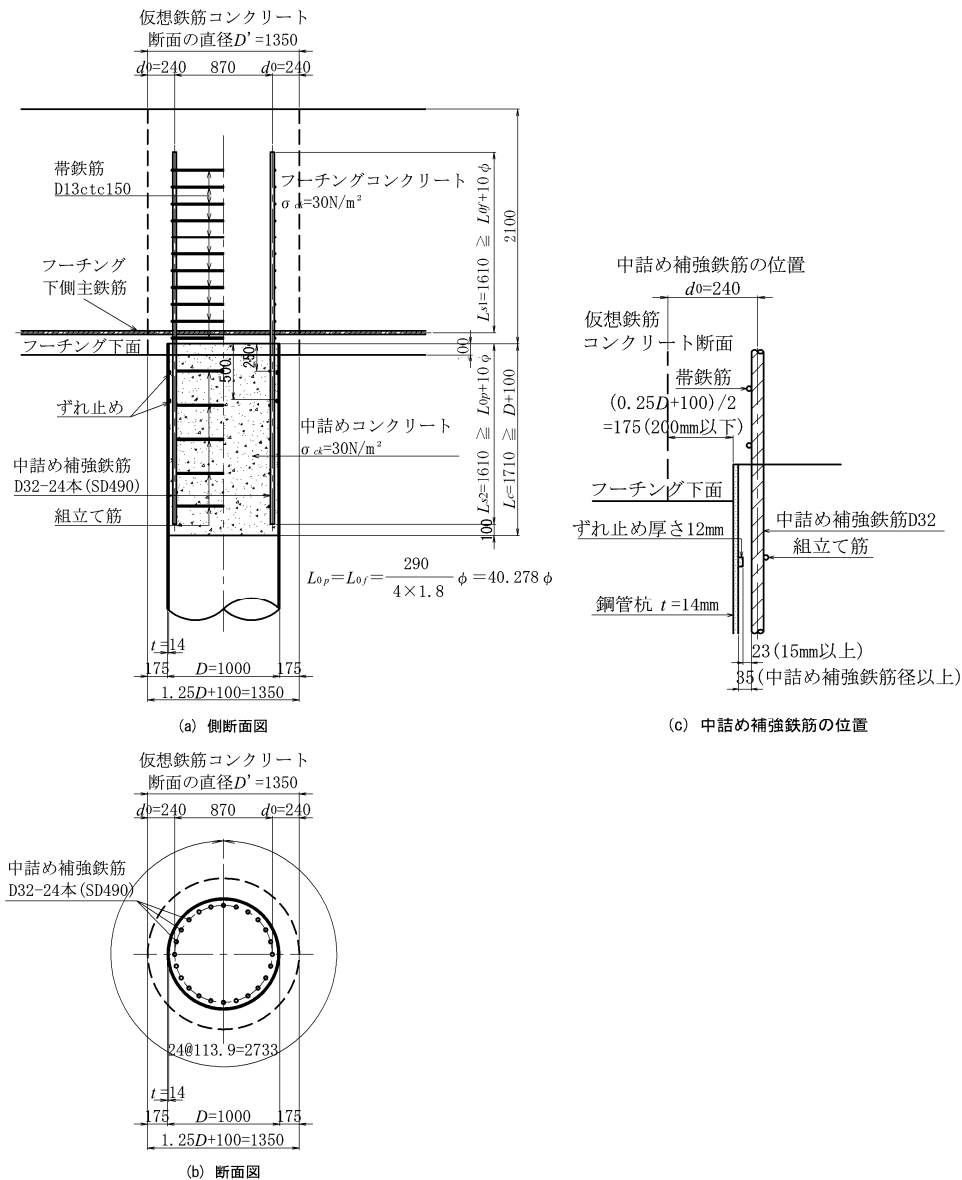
鋼管杭の接合部と仮想鉄筋コンクリート断面
